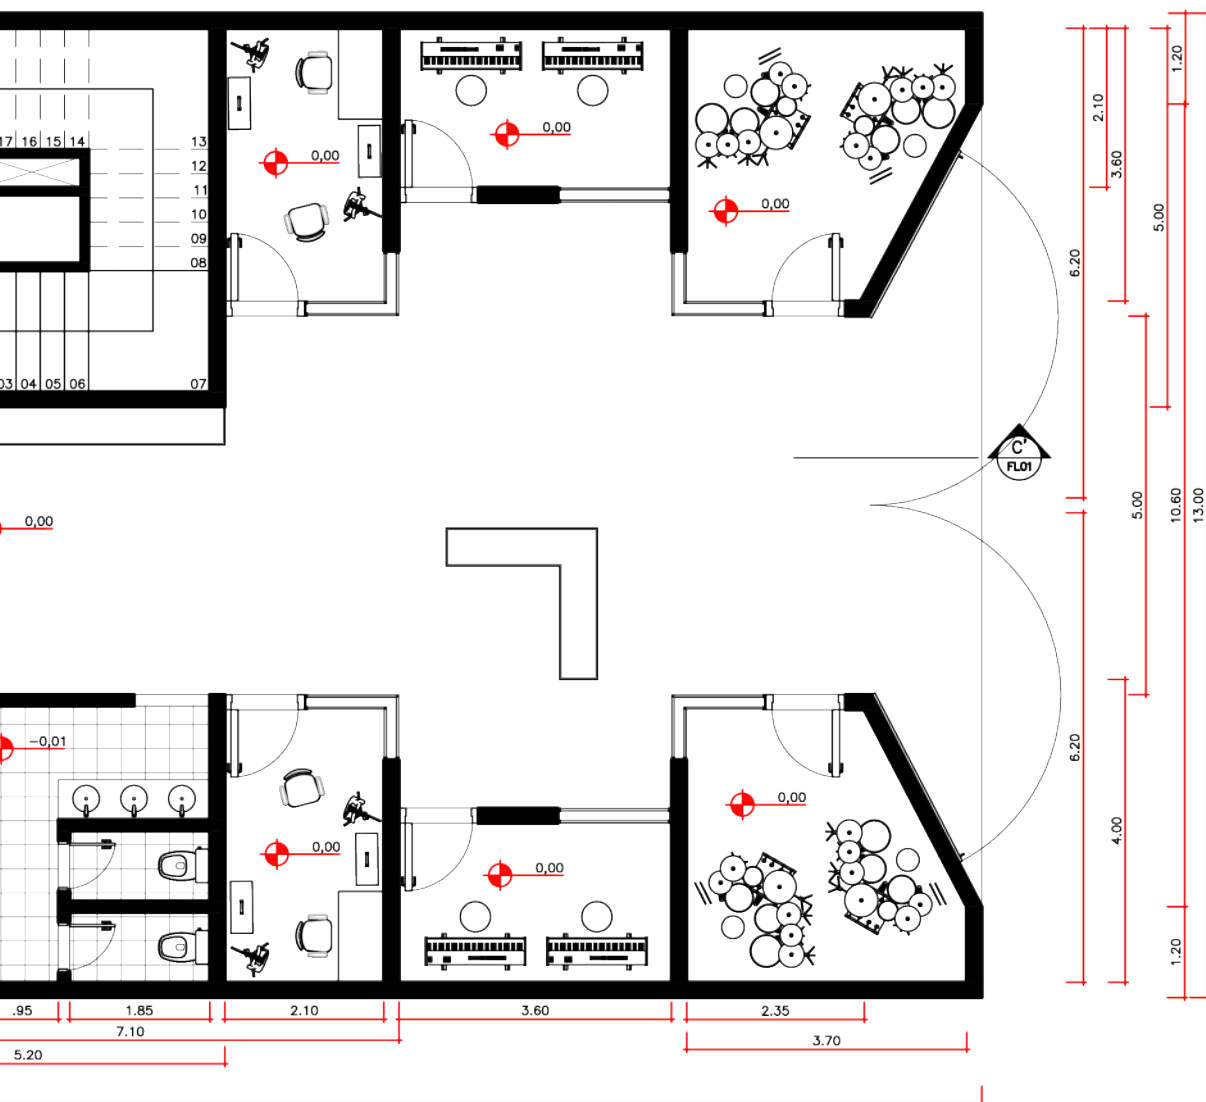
BLOCO DE SALAS DE AULA - PLANTA -1 - ESC.: 1:100
